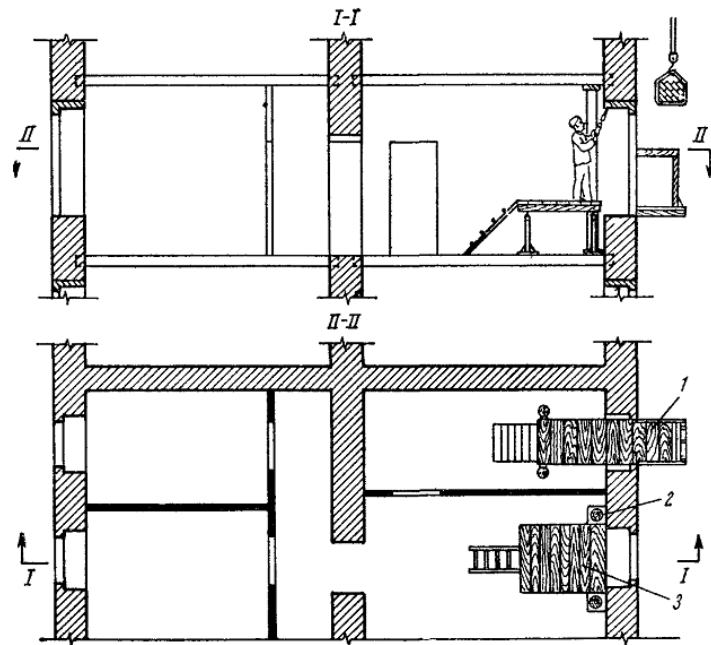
Общая схема организации работ по замене кирпичной перемычки сборной железобетонной
